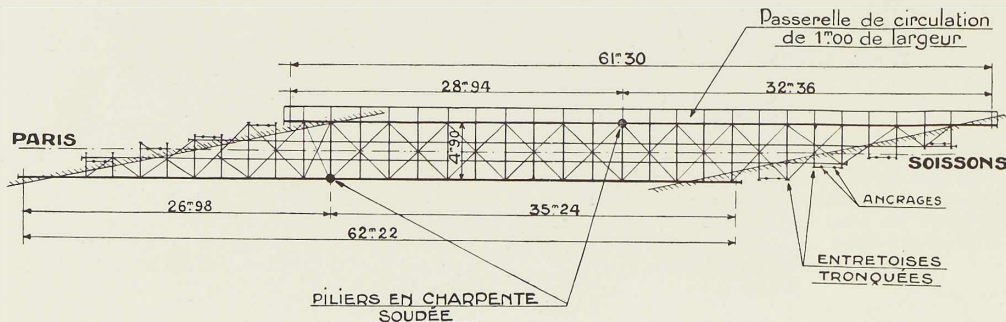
Vue en plan du nouveau pont soudé.
